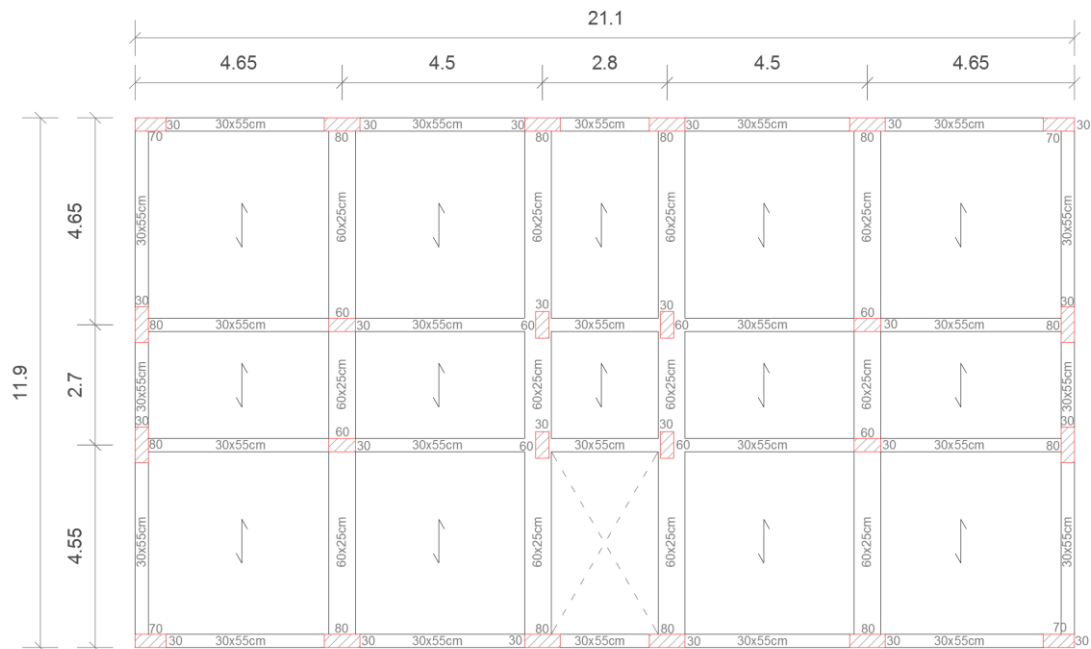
Carpenteria primo solaio struttura in c.a. a due piani.
